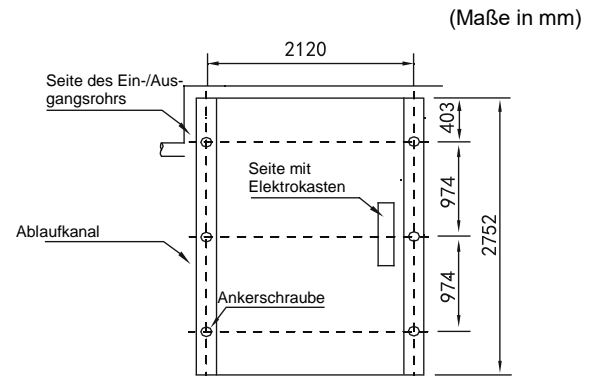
Skizze der Installationsmaße für SCV-1800EBH – Draufsicht
